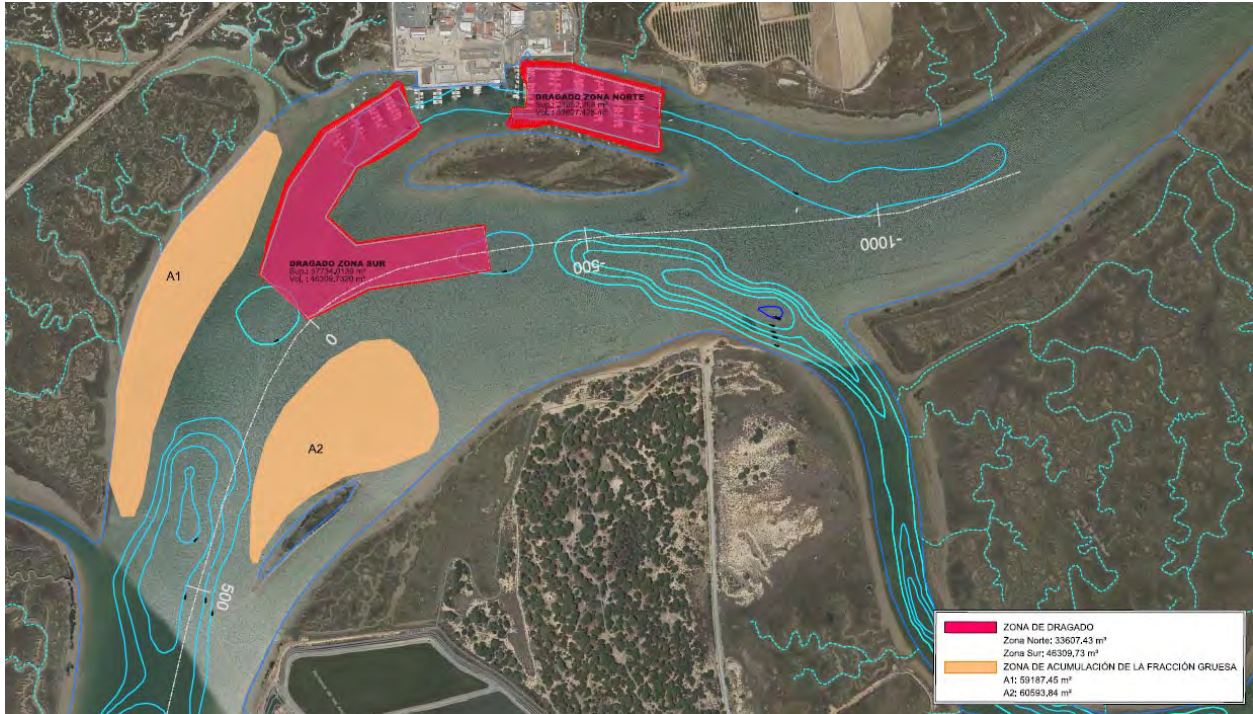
Planta de la propuesta de dragado en el puerto de El Terrón.
